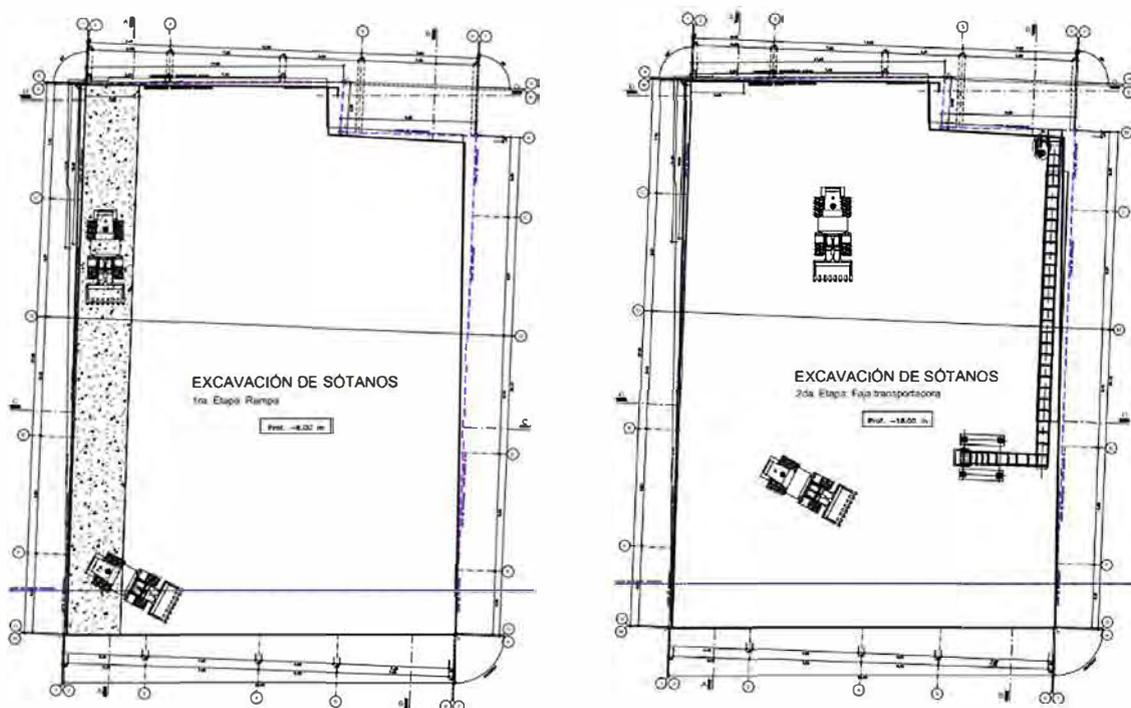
Esquema de rampa (izquierda) y de fajas transportadoras (derecha) para el sistema mixto planteado
